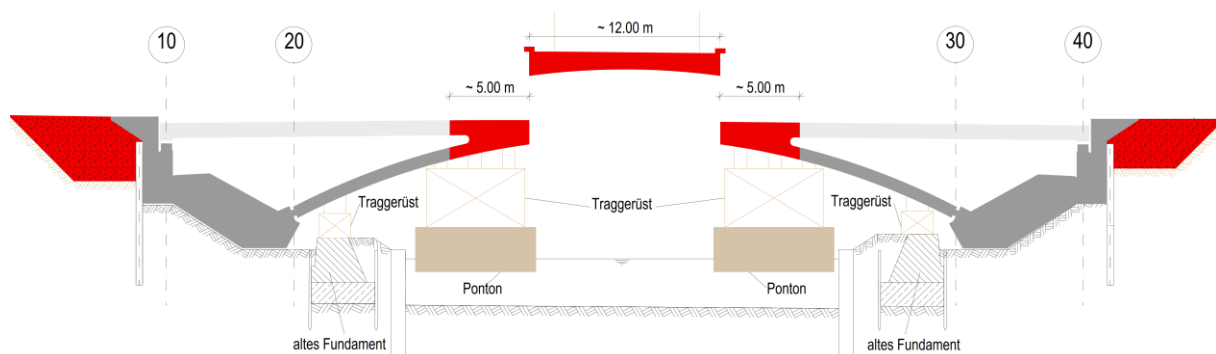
Prinzipskizze Montage Mittelteilschüsse
